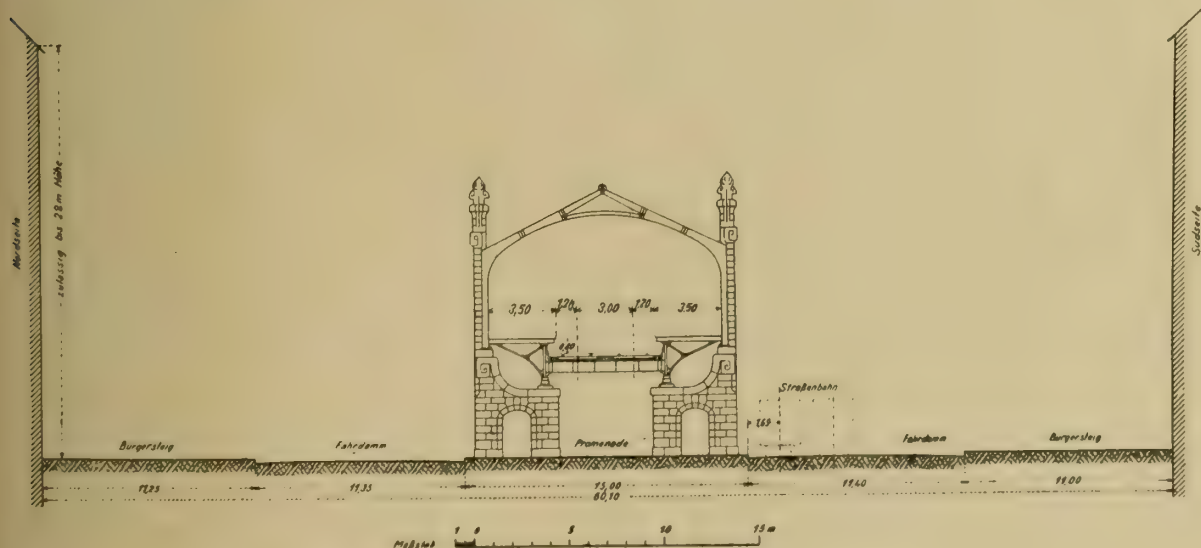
Bülowstraße mit Haltestelle Bülowstraße.
